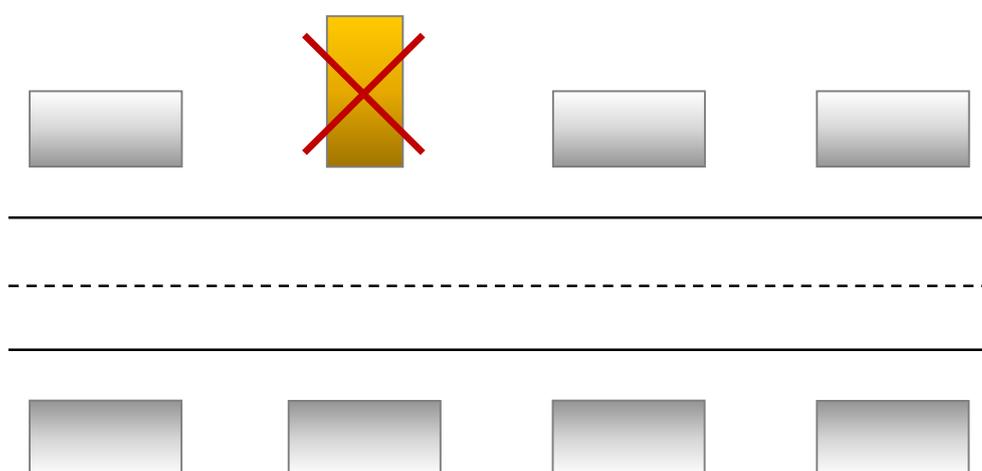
EN ORANGE : EXEMPLE DE MAUVAISE ORIENTATION D'UNE NOUVELLE CONSTRUCTION (VUE EN PLAN)
